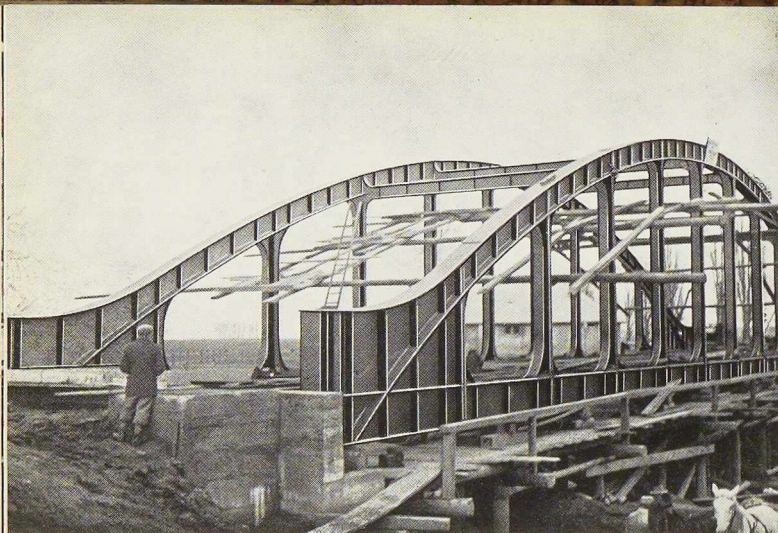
Le pont Vierendeel soudé en cours de montage.
